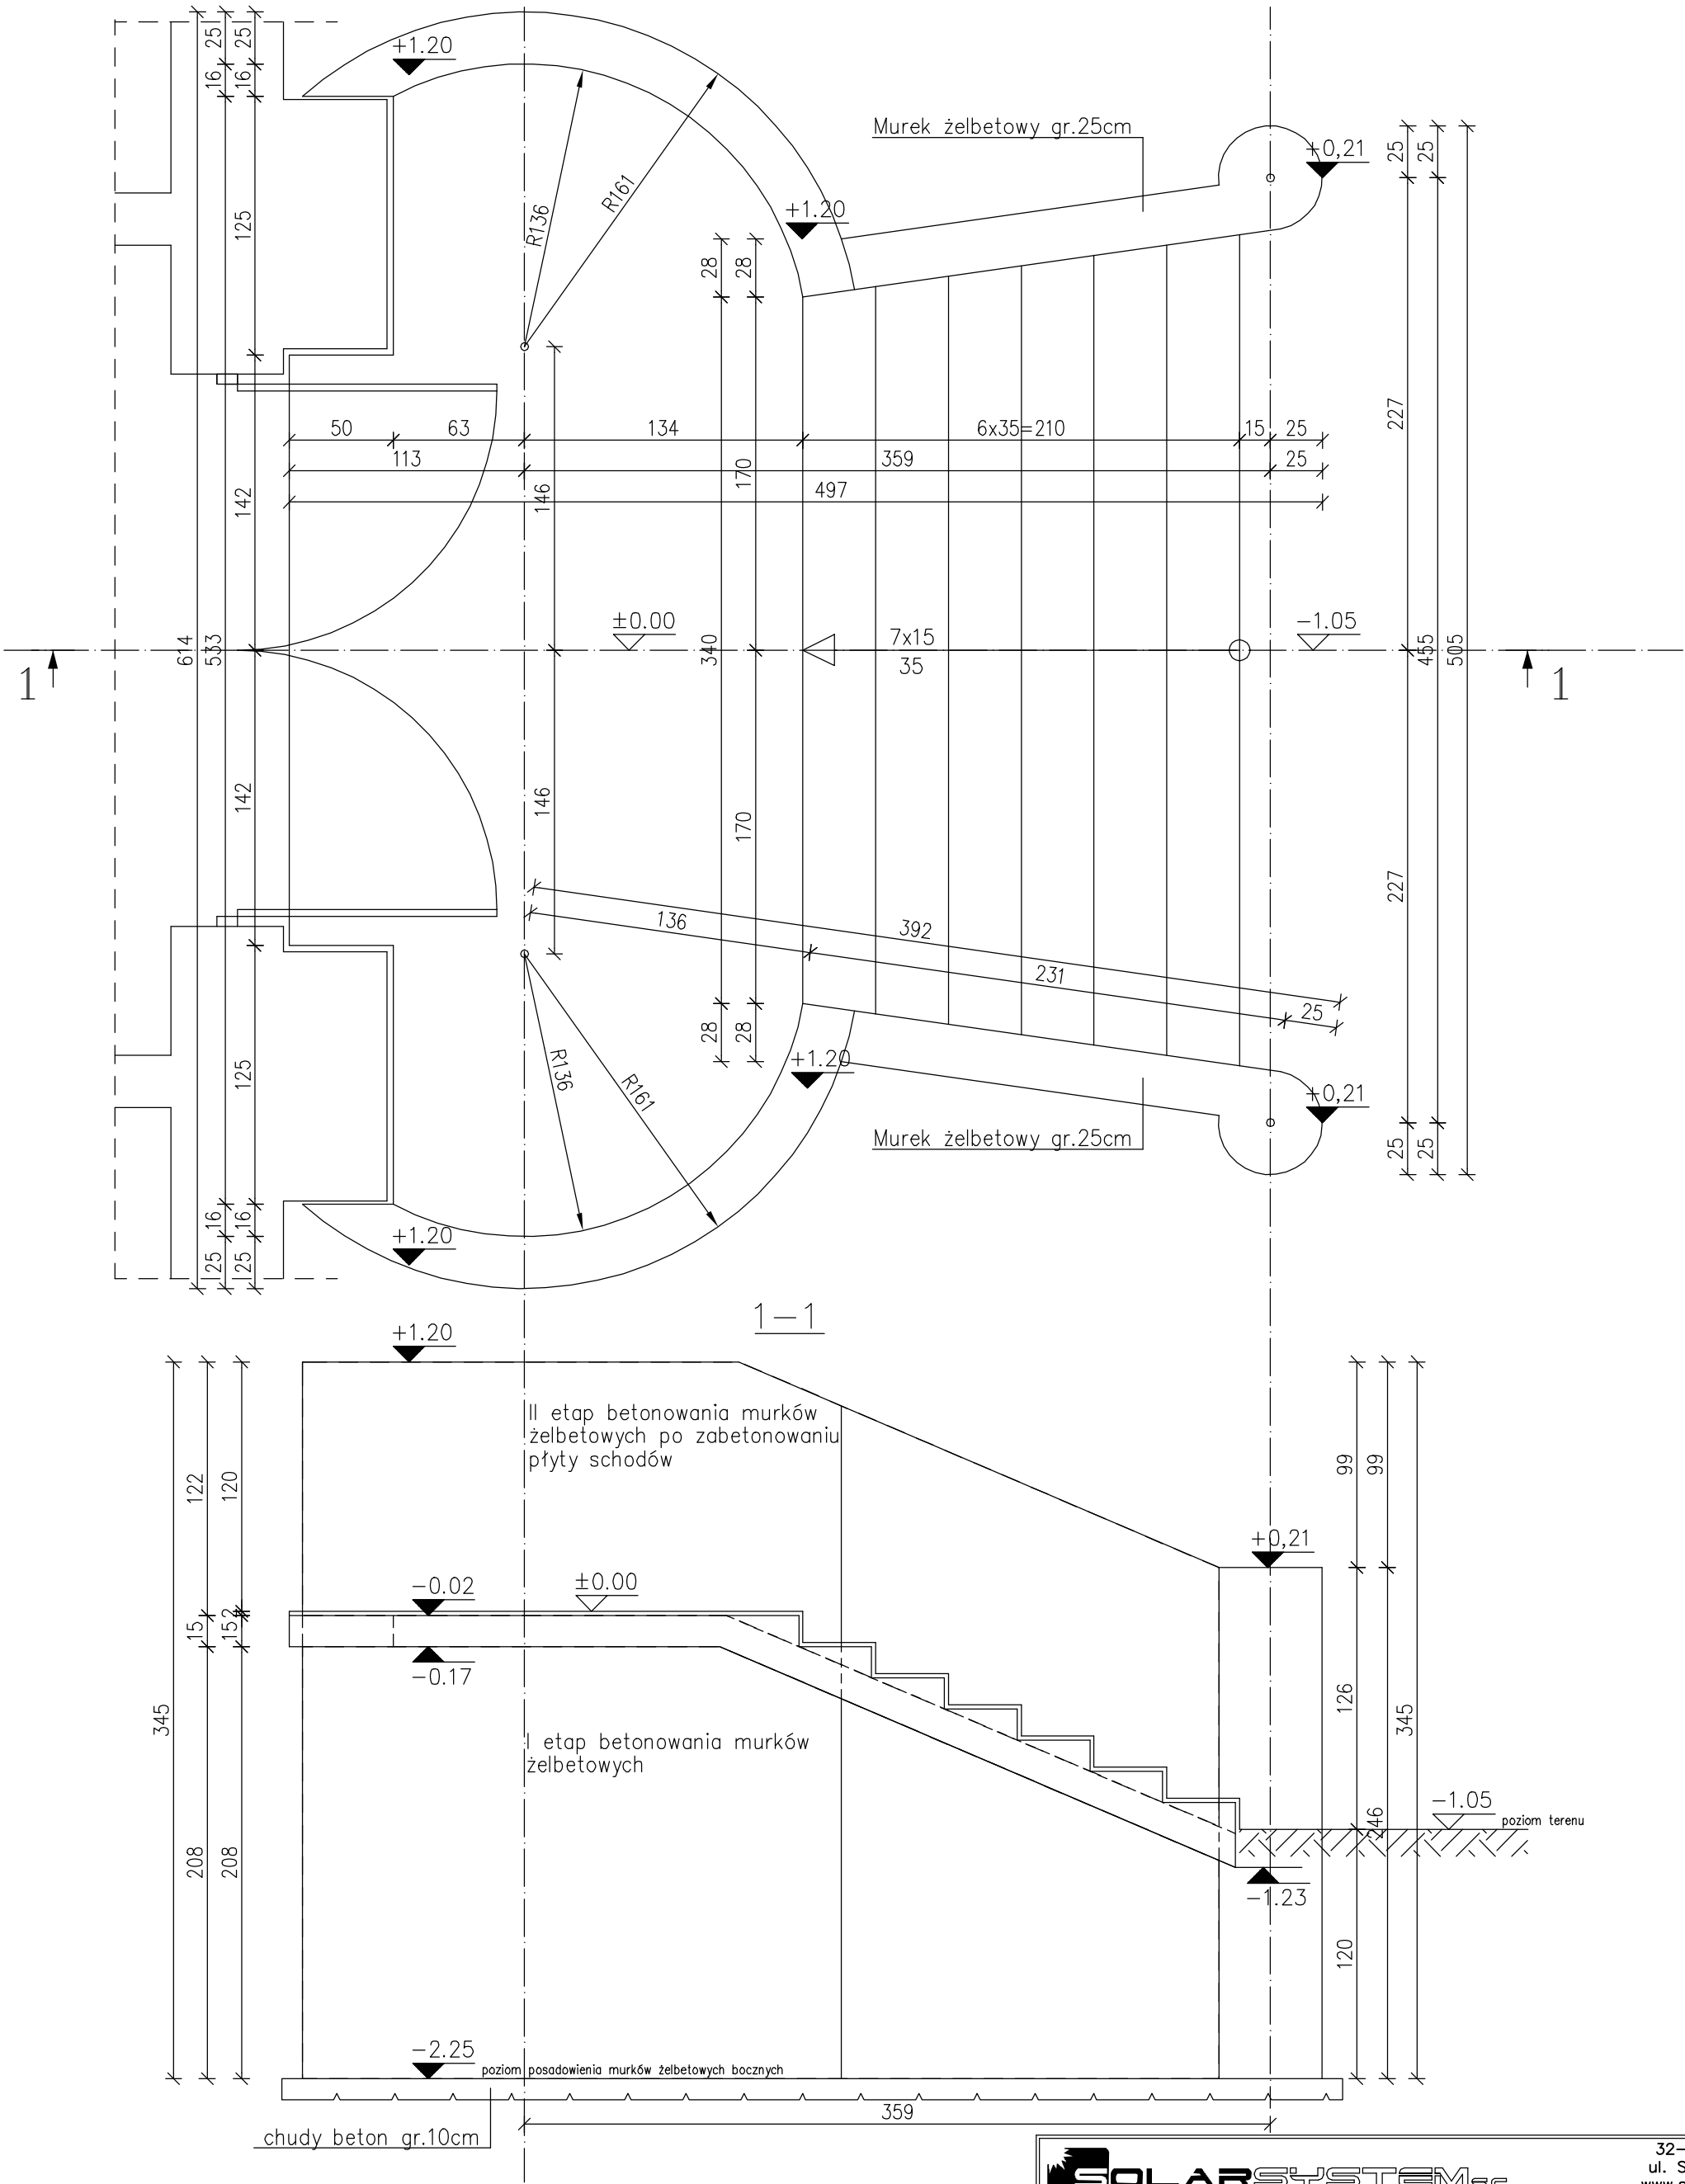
Schody żelbetowe nr2- plan szalunkowy 1:30
